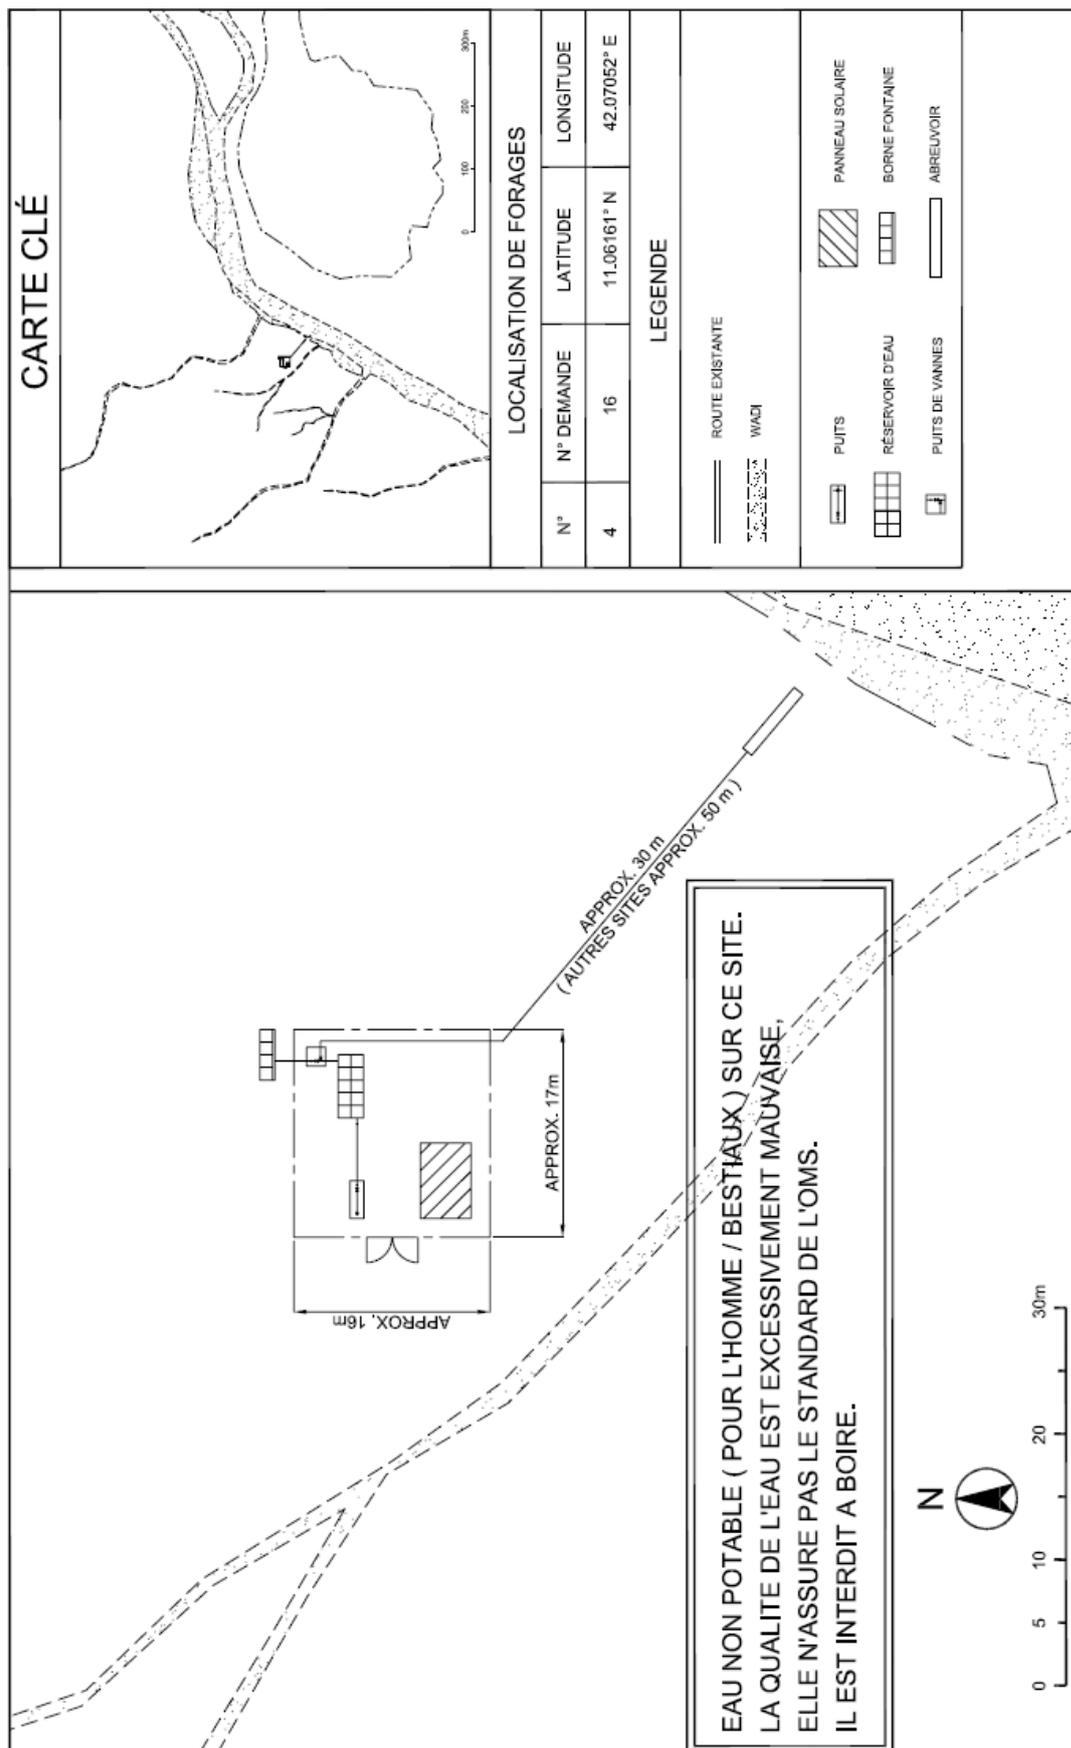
Plan d'implantation des installations (v) [Asa Koma]
